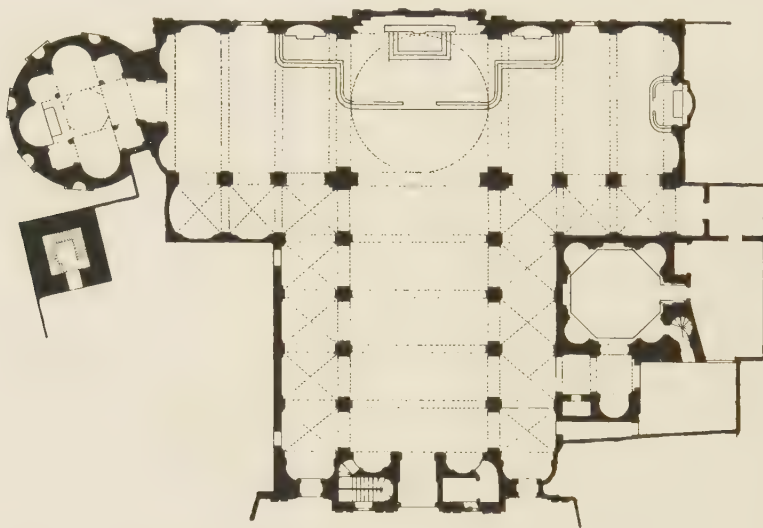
Planimetria del progetto definitivo della chiesa di Santa Maria di San Satiro (1482-1487) con la fronte attuale.
